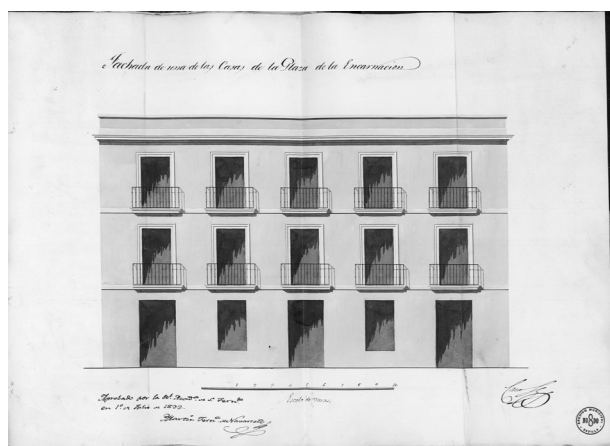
Melchor Cano. Alzado de fachada para la plaza de la Encarnación. 1832. Sevilla. AHMS.
